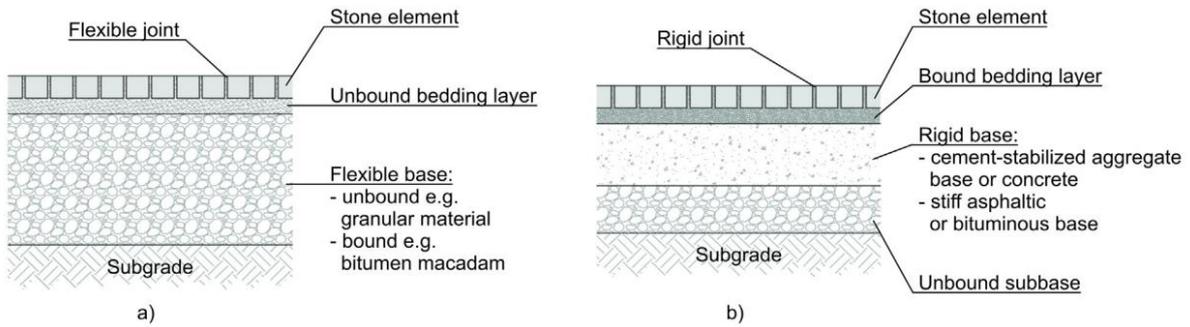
Tipos de pavimentos discontinuos. Flexible (a) y rígido (b).
